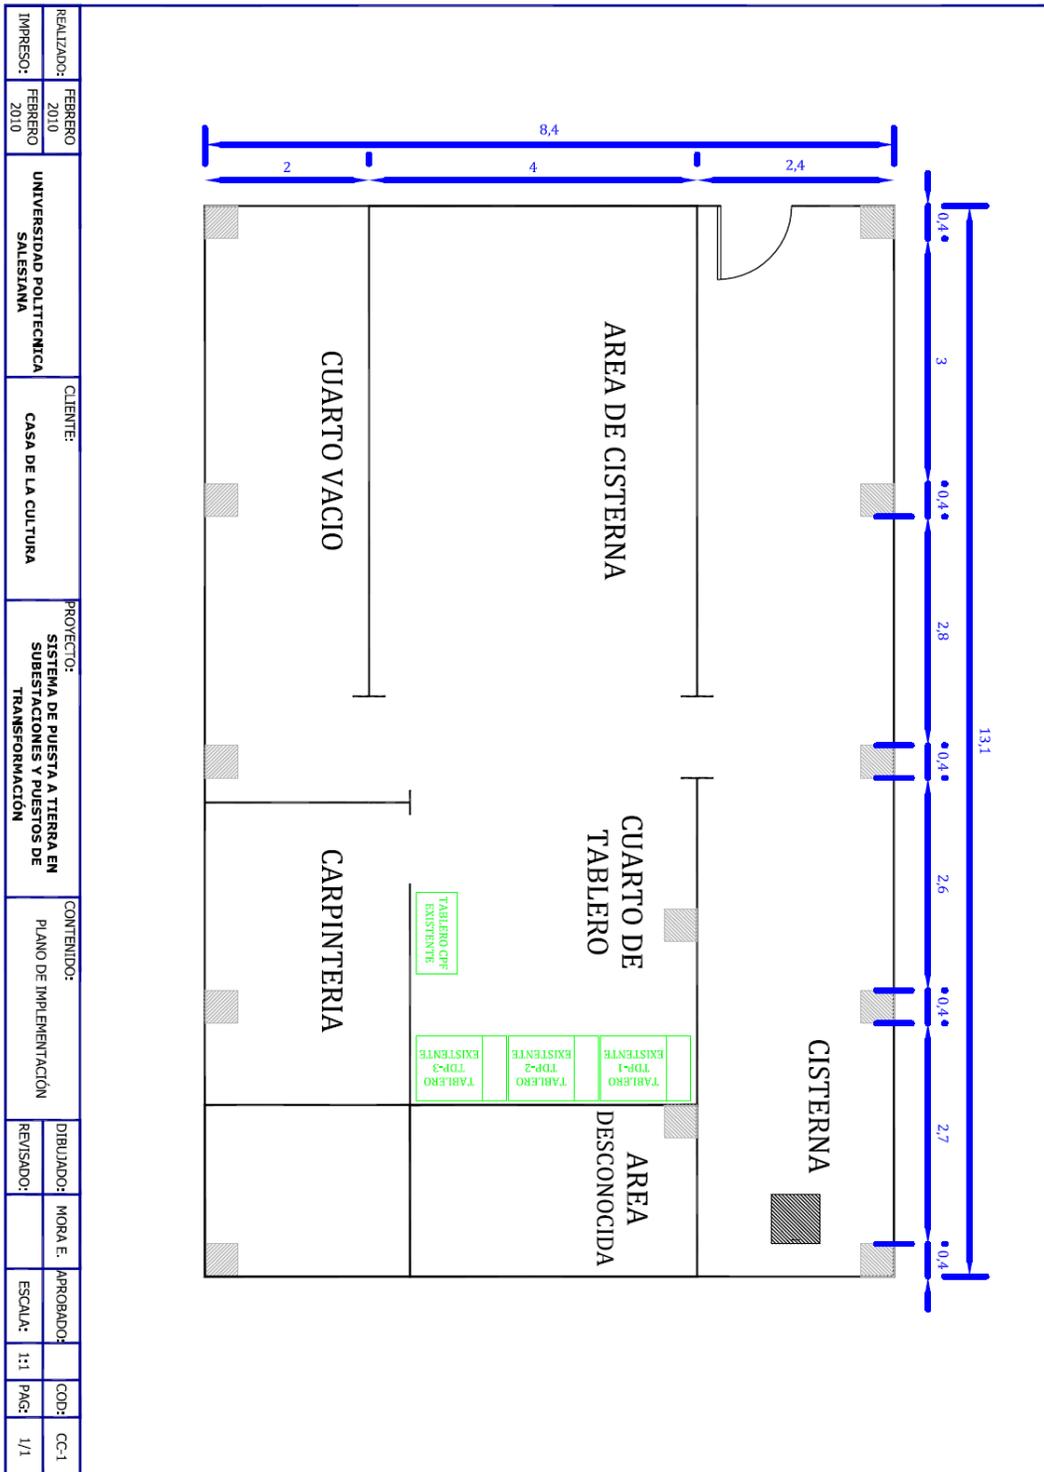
Plano vista superior planta baja de la Casa de la Cultura
